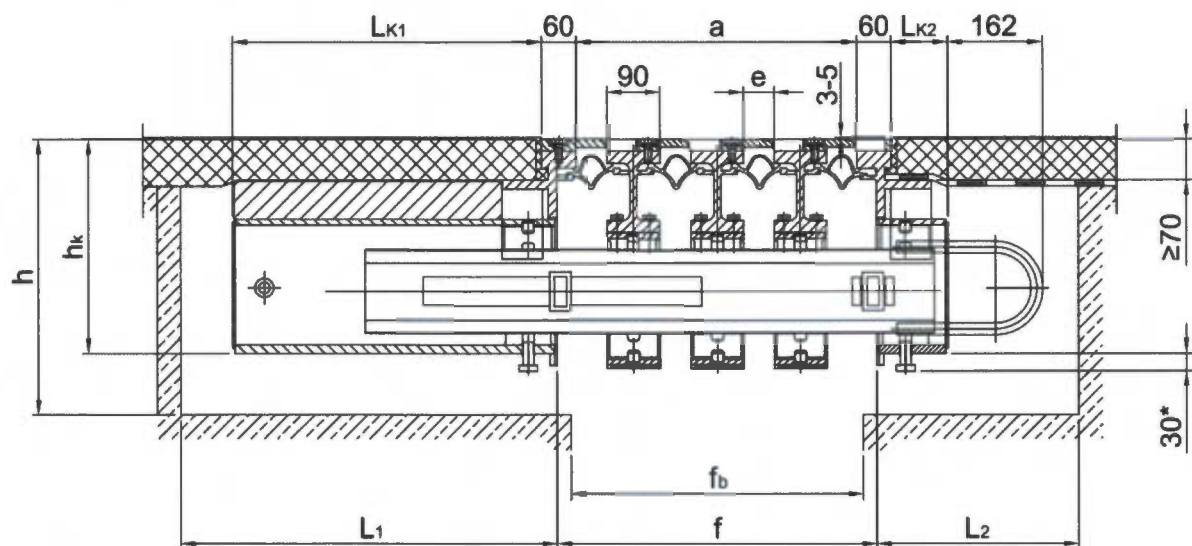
Situation und Bezeichnungen zu den Aussparungsabmessungen
